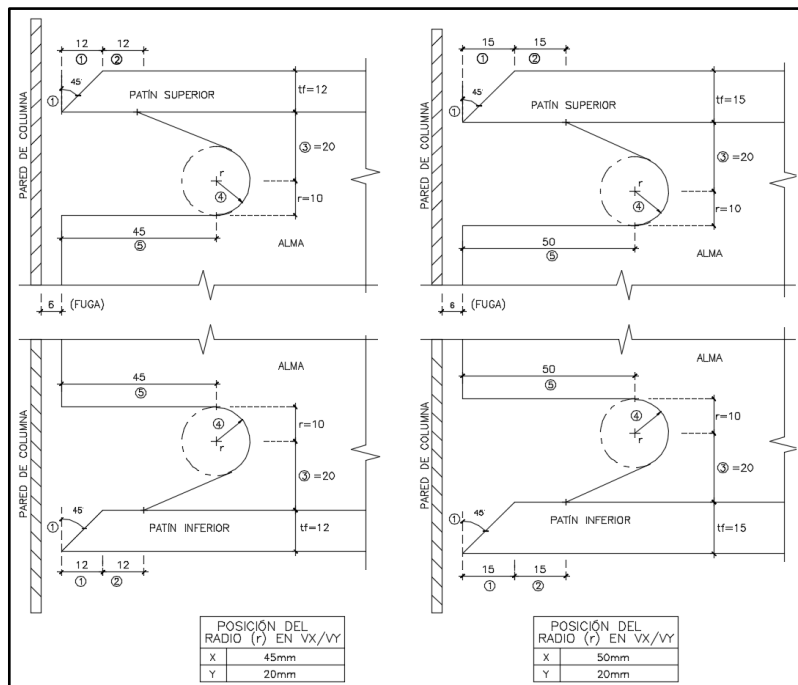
Geometría de agujero de acceso para soldadura $t_f=12-15\text{mm}$.
